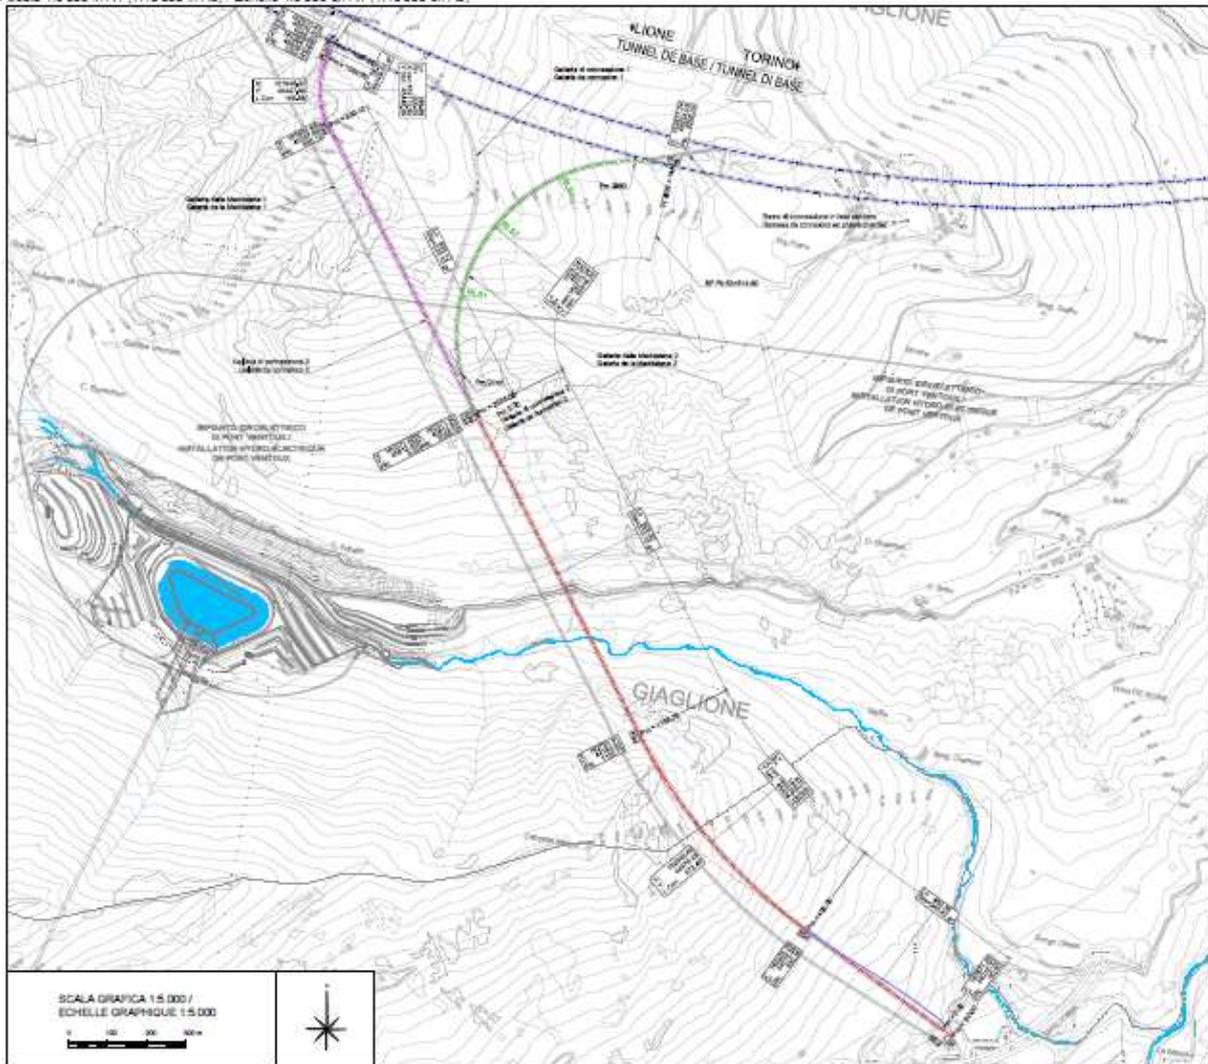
Planimetria della Galleria Maddalena 2 e della galleria di Connessione 2
